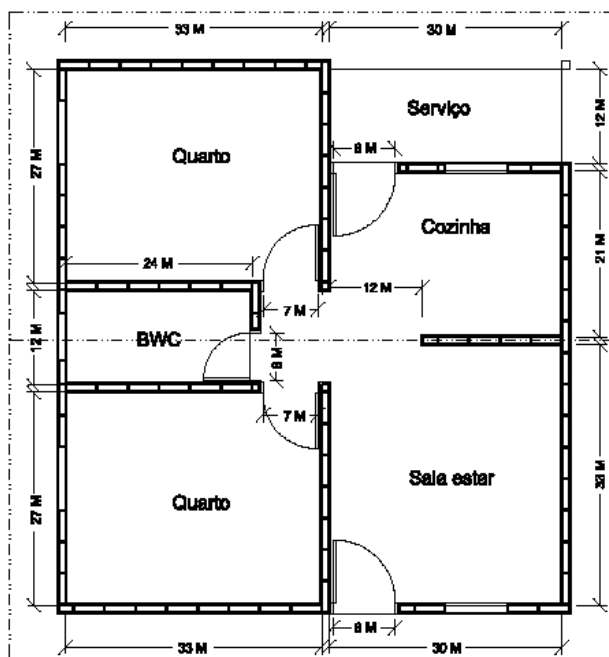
Planta Baixa da proposta da habitação do estudo de caso 1 usando a coordenação modular.
